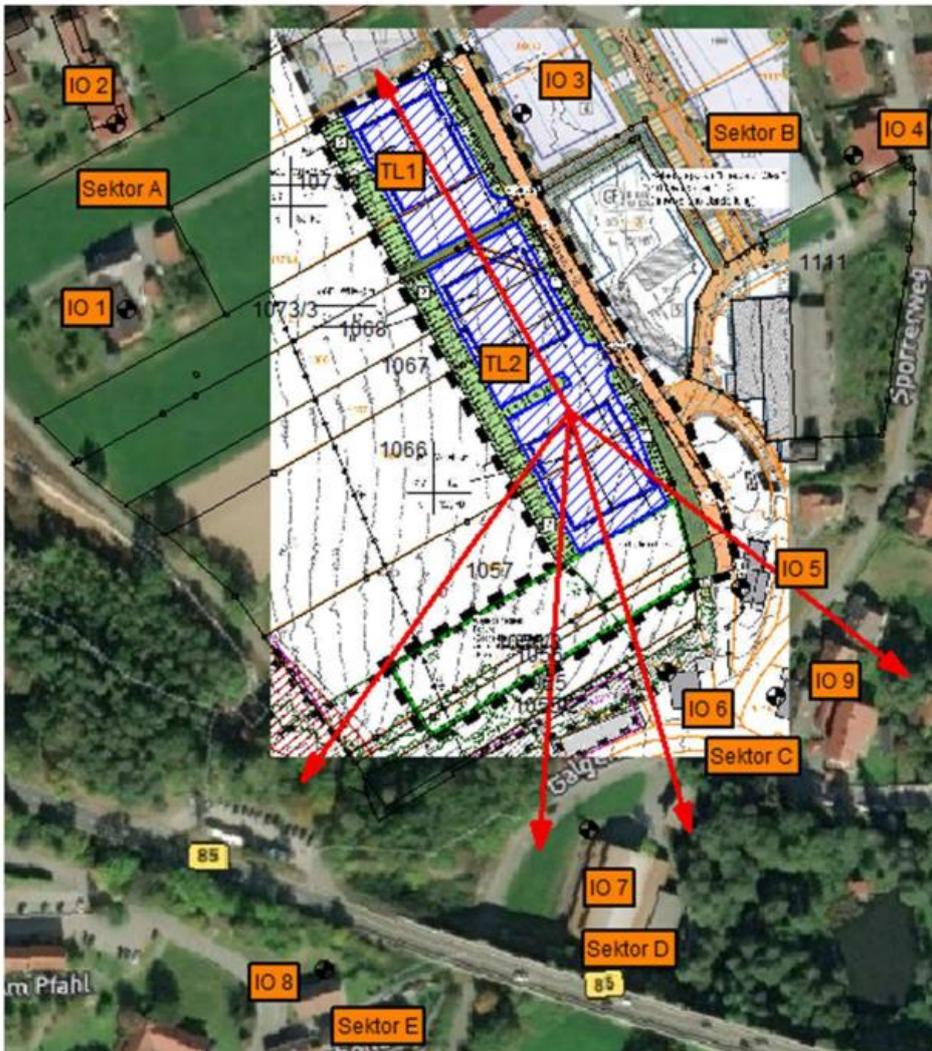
Lageplan mit Kennzeichnung der Immissionsorte IO1 – IO9, Dezember 2022 (Quelle: GeoPlan GmbH)
